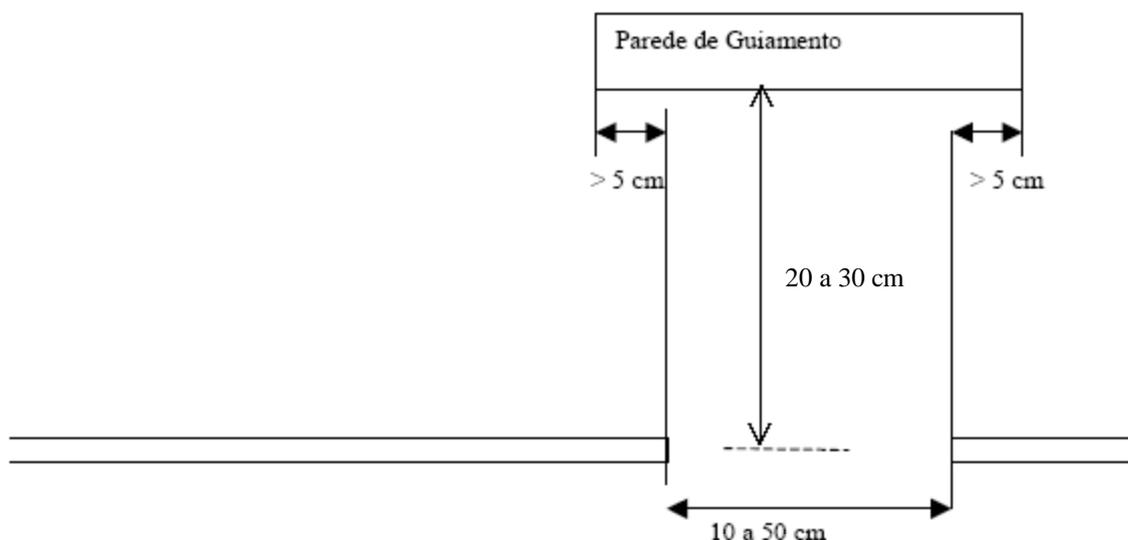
Detalhe de uma zona de interrupção da pista (em recta). Caso a interrupção fosse em curva a parede de guiamento seguiria paralelamente à curva
